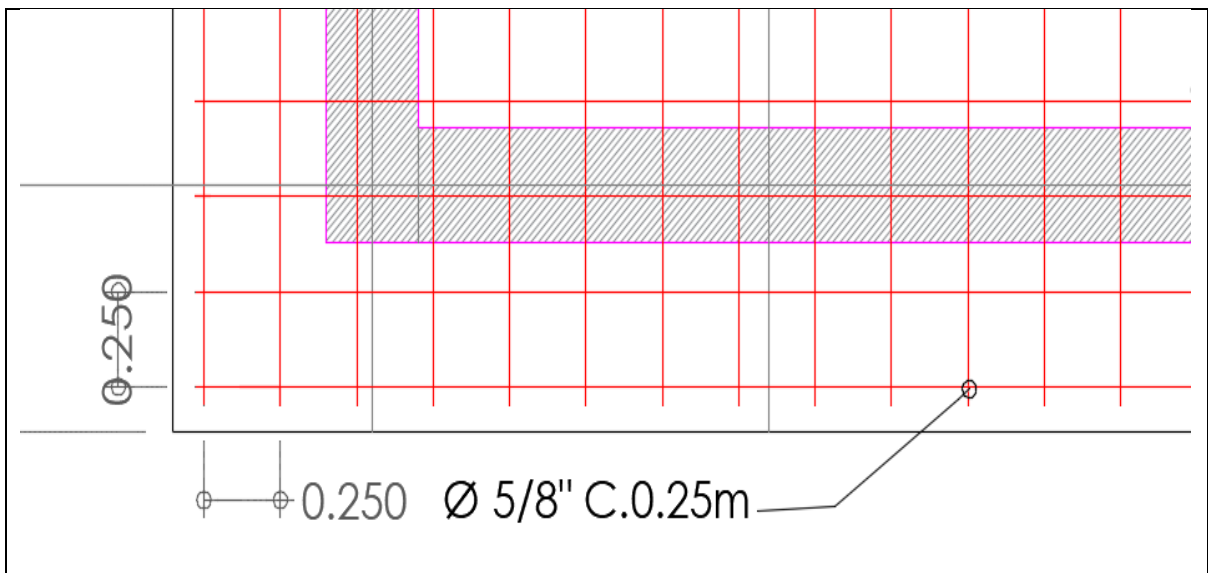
Seguimiento de obra: Detalle estructural losa inferior desarenador
